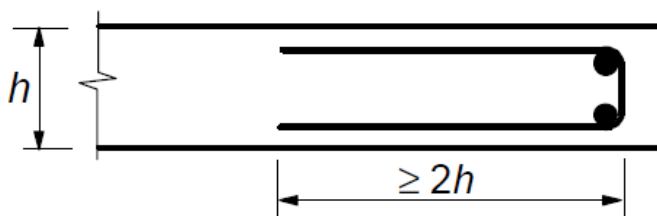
Armadura de bordo livre numa laje [12].
